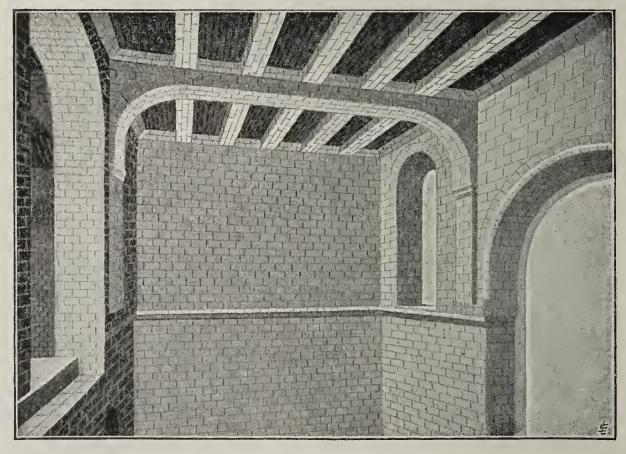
Eggertdecke im Rathaus zu Hannover.
